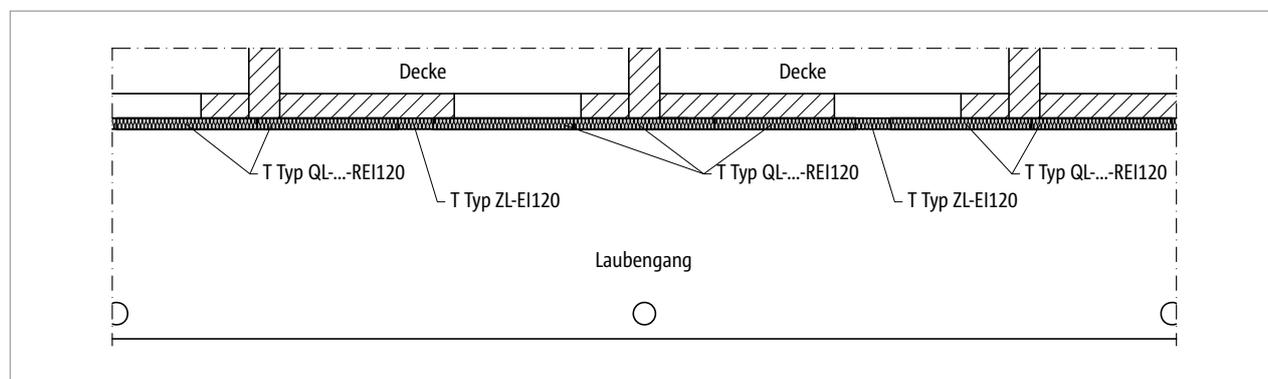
Schöck Isokorb® T Typ QL-...-REI120, Typ ZL-EI120: Laubengang raumabschliessend
